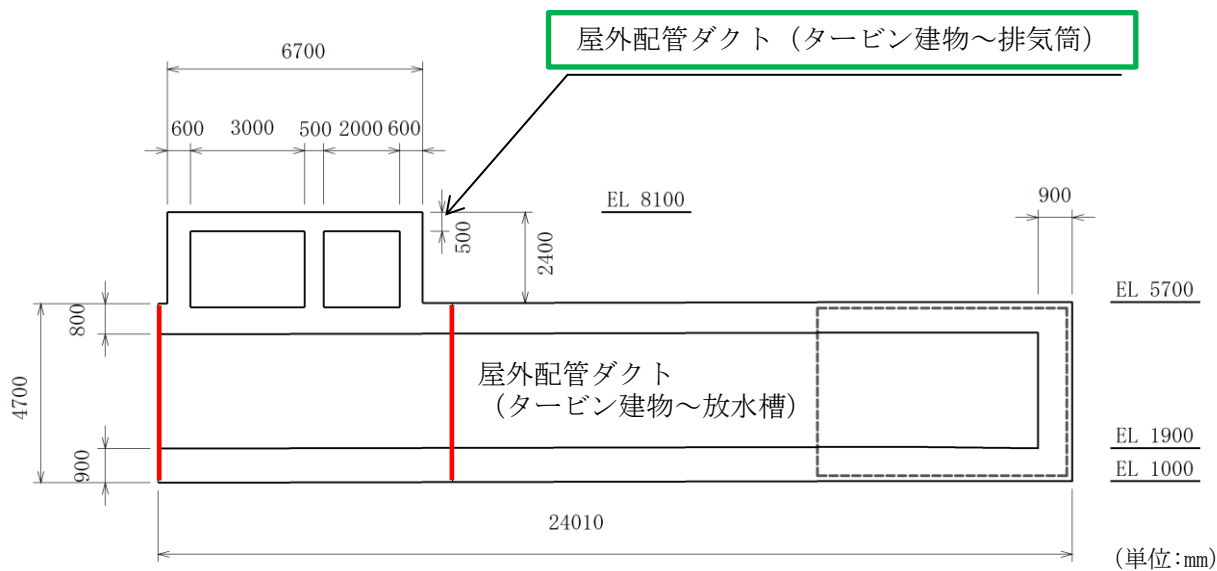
屋外配管ダクト（タービン建物～排気筒） 断面図（B-B断面）
